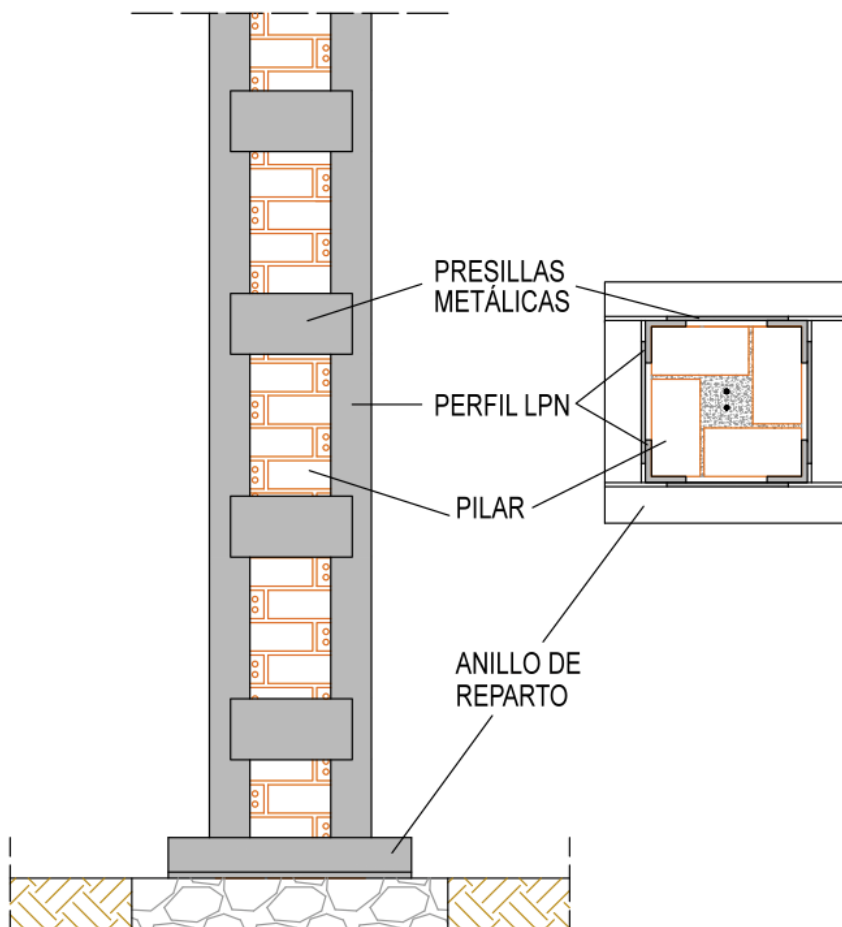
Propuesta de intervención en pilares. Fuente propia.
